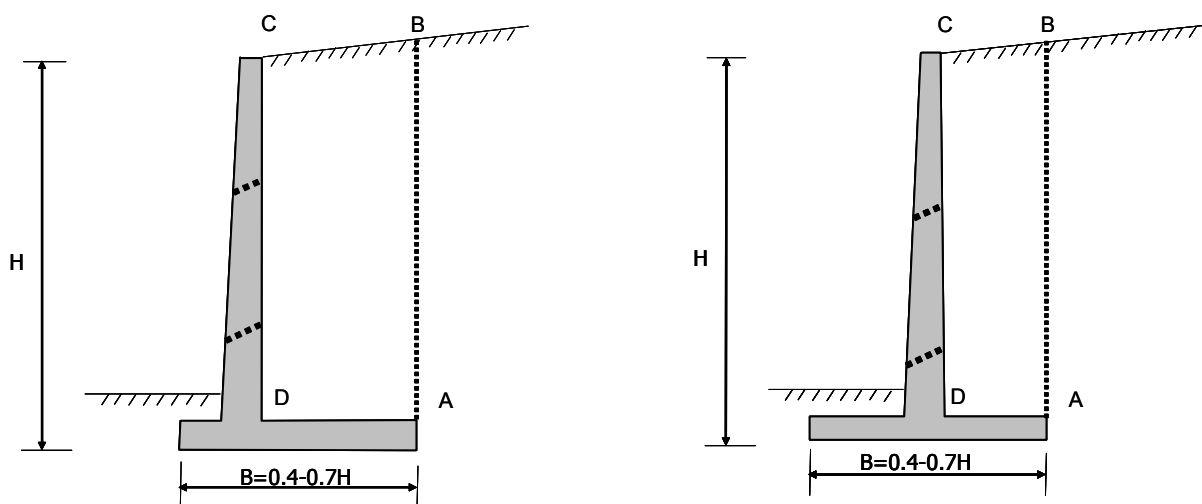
Principali tipologie di muri a mensola: a sinistra muro ad L e a destra muro a T rovesciato; le linee tratteggiate rappresentano i dreni sulla porzione verticale del muro -
